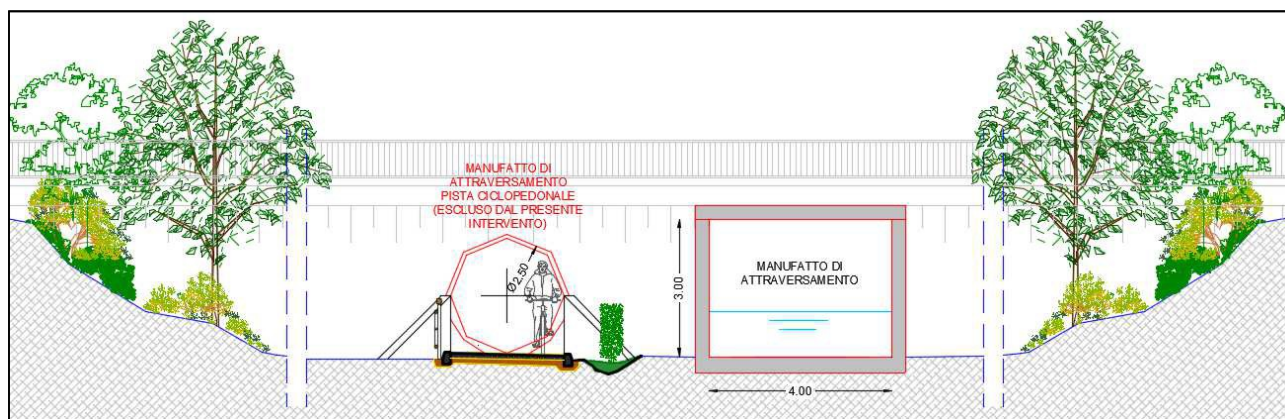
Attraversamento Via Fancello – Sezione rettangolare in c.a
